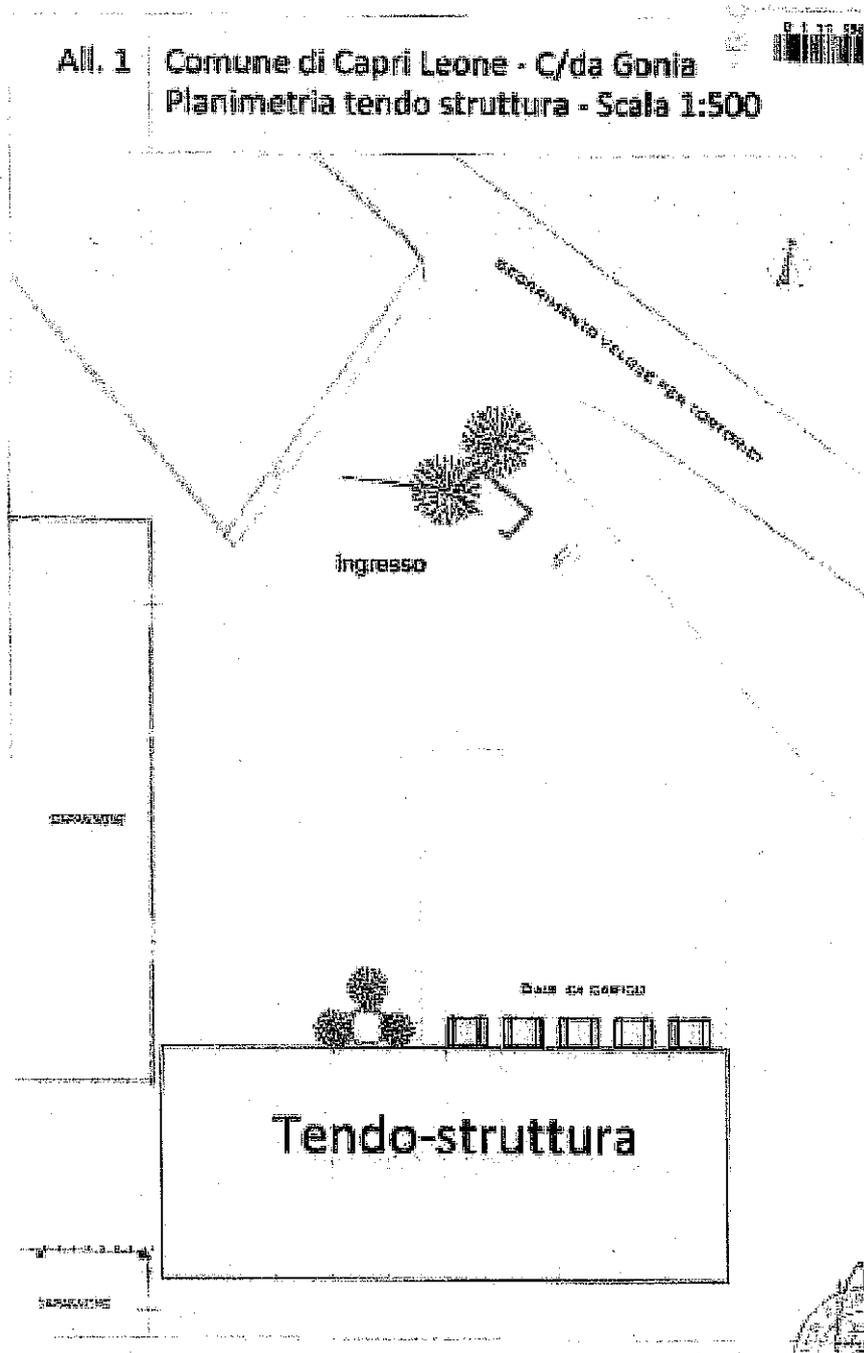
Dislocazione della tendo – struttura (Lotto – 04).
